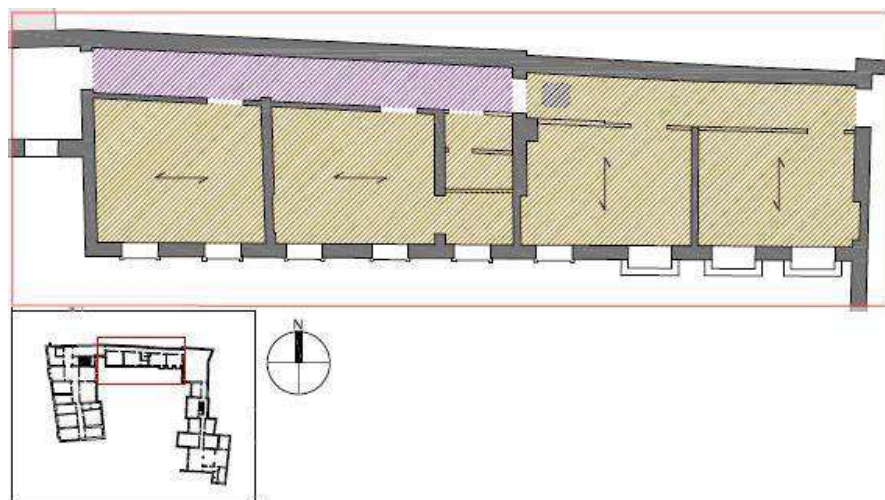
Secondo orizzontamento rilievo strutturale
